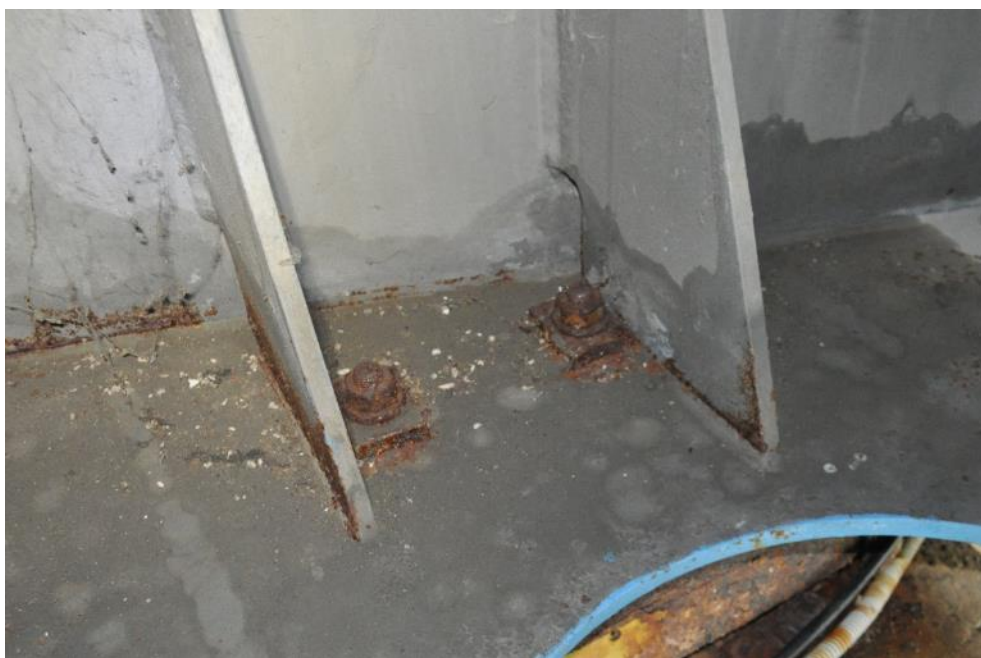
Балка Б-3 пролетного строения на крайней опоре №2.
